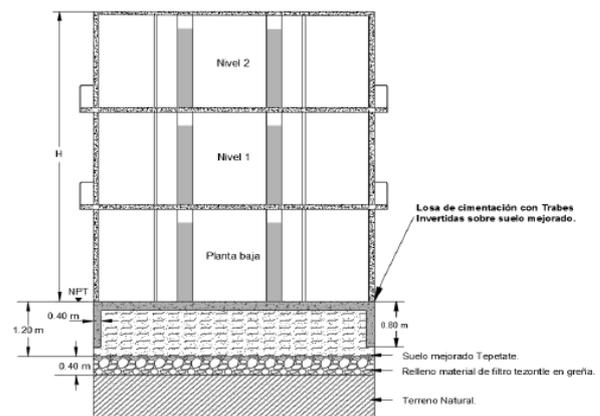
Propuesta de losa de cimentación con traves invertidas en corte longitudinal del edificio.
